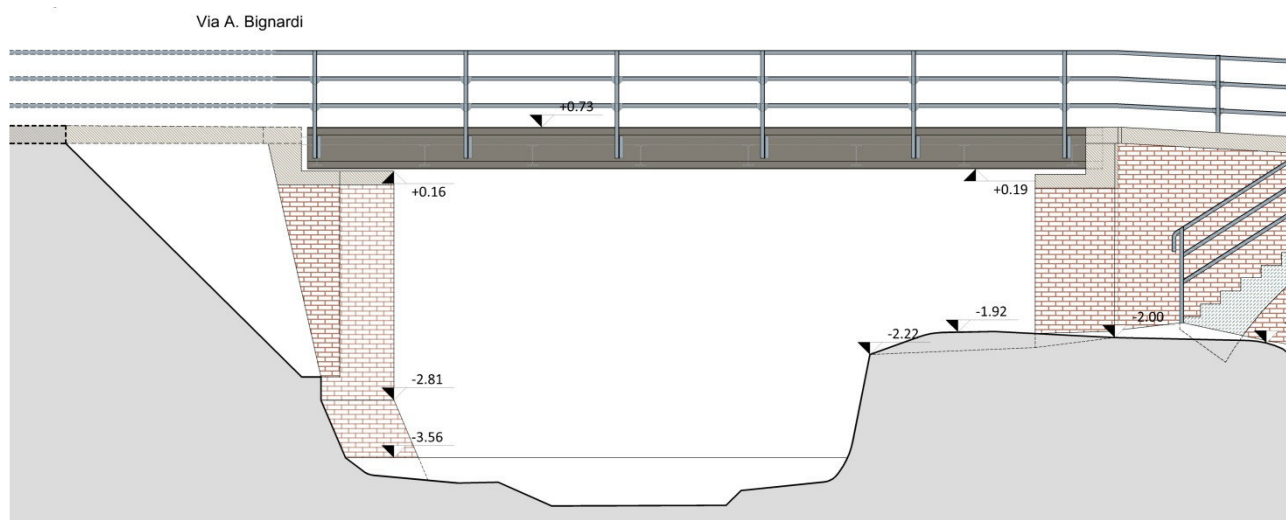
Prospetto nord, ponte in ferro – La campata orientale è realizzata con elementi in ferro, a cui sono collegati i montanti del parapetto in ferro. Le spalle della campata sono in mattoni pieni di laterizio e presentano un cordolo intonacato in sommità.
